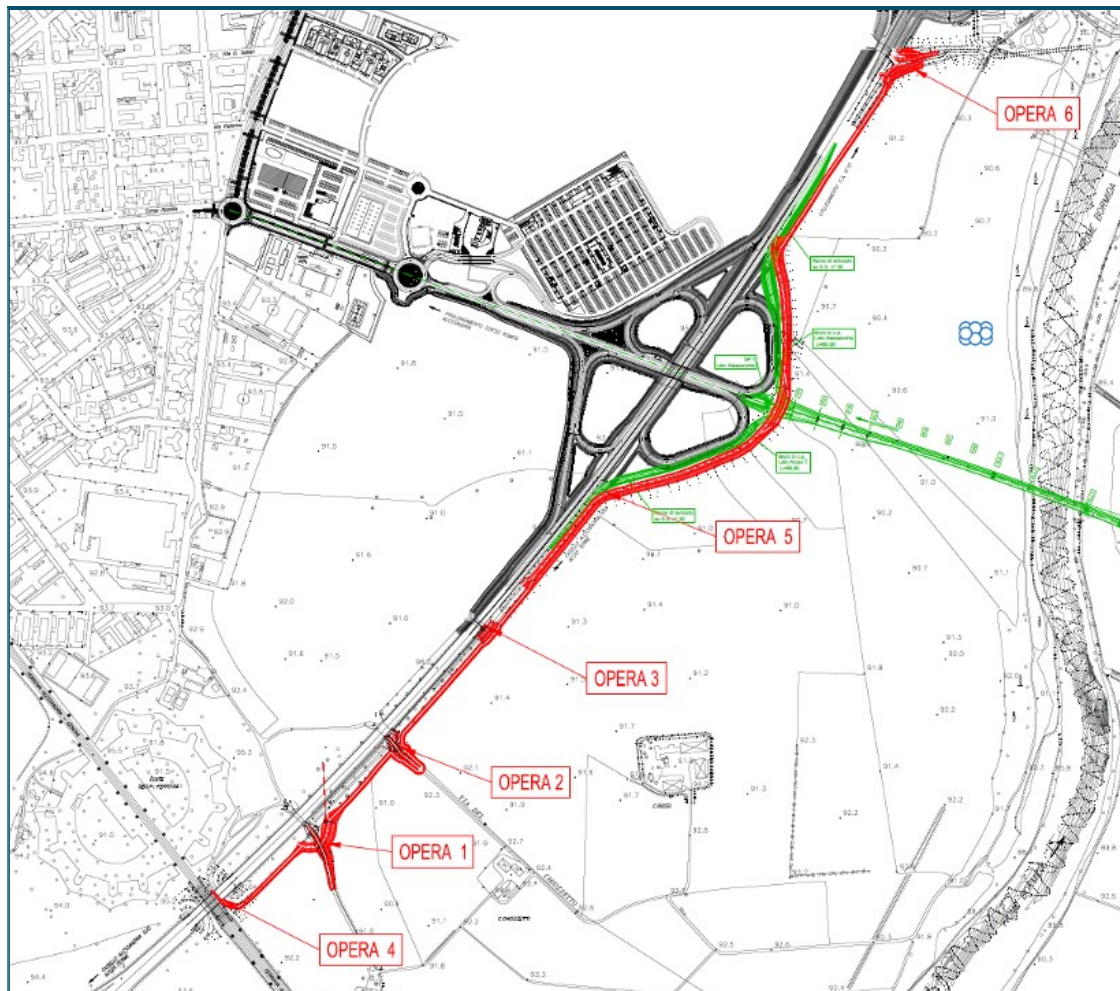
Stralcio planimetrico di progetto con individuazione su CTR degli interventi
